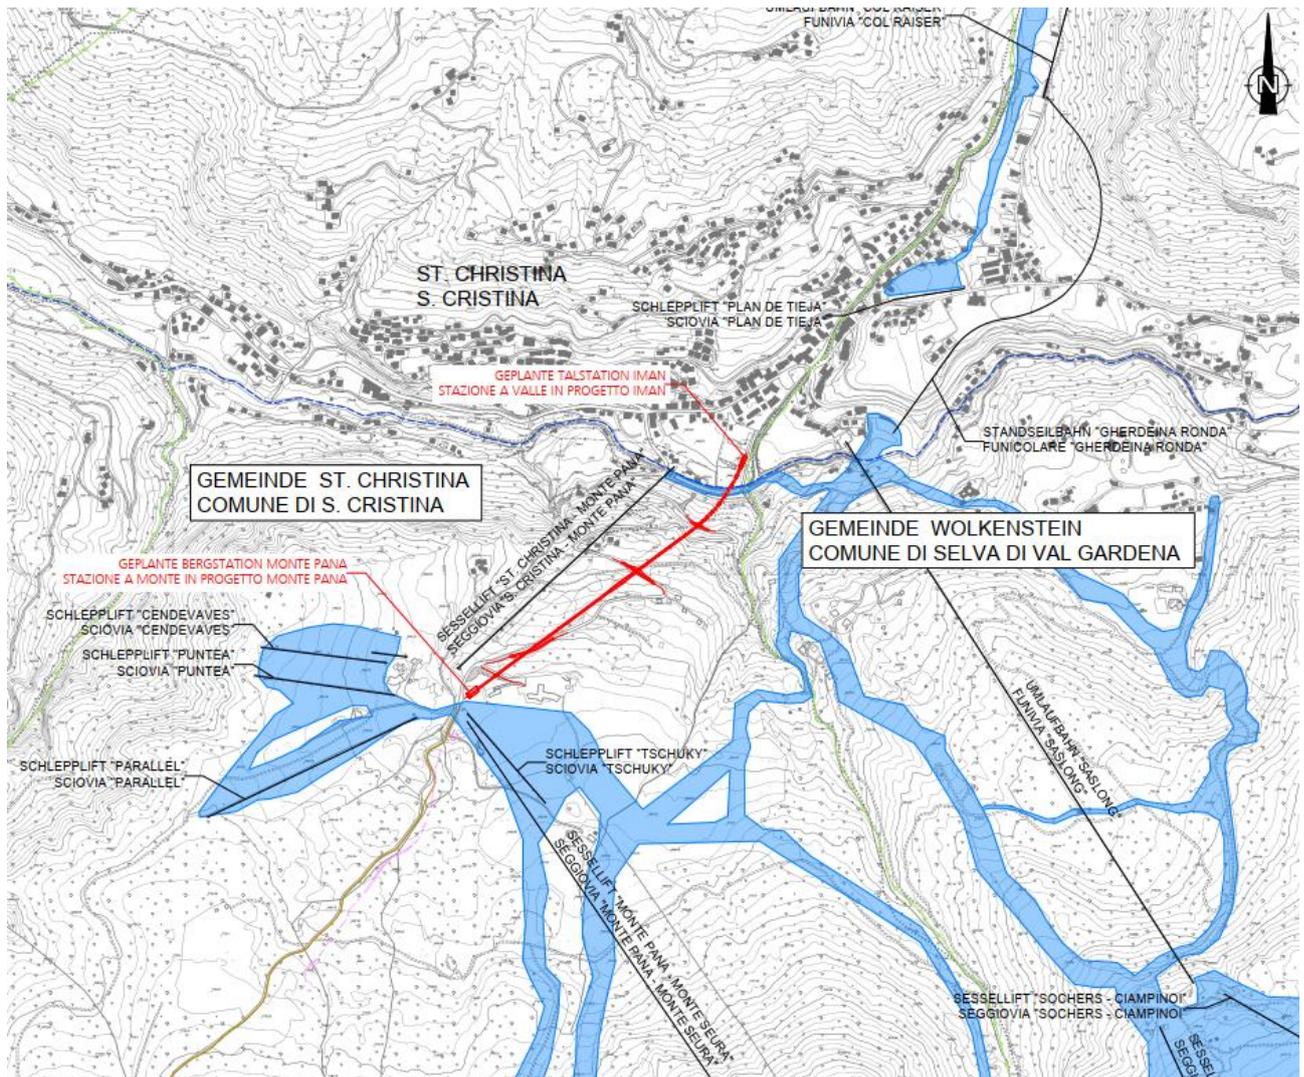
Übersichtslageplan Projektgebiet mit geplanter Standseilbahn
